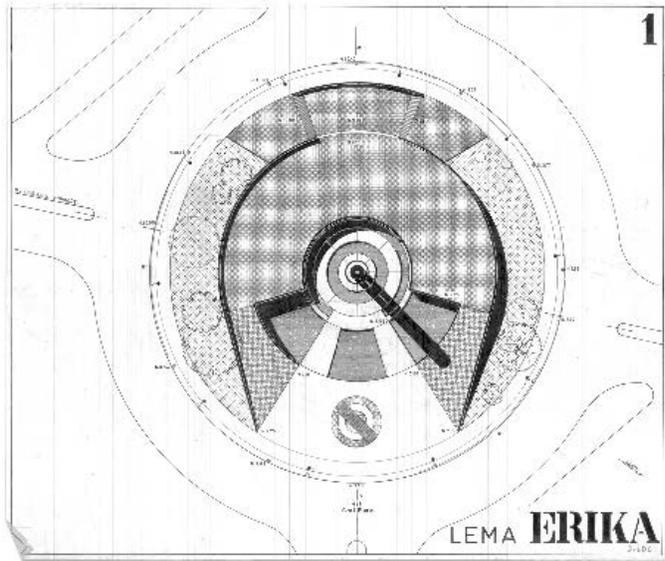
PLAZA DEL EJÉRCITO. ROBERTO ELZAURDÍA. PLANTA, PROYECTO DE 1974.
